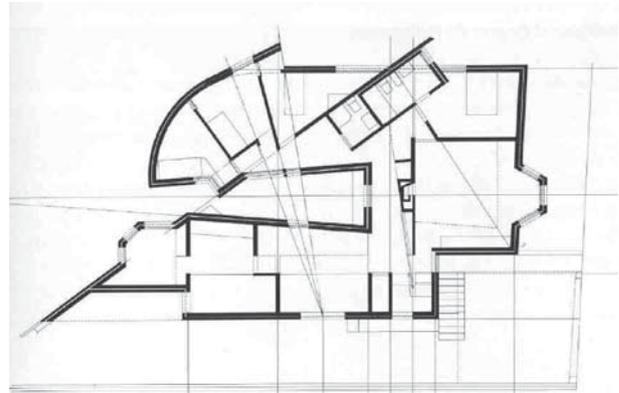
Planta baixa. Fonte: TESTA, 1998, p. 50-51.
